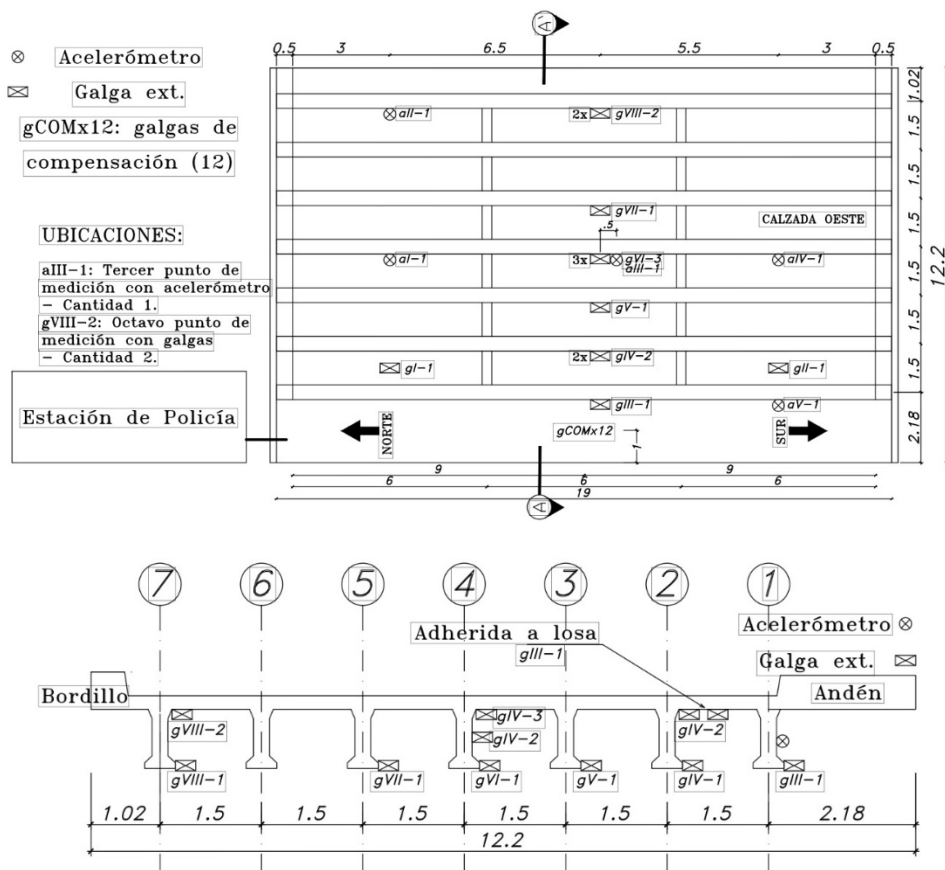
Arreglo definitivo de acelerómetros y galgas: a) vista en planta, y b) vista en elevación (corte A-A')
